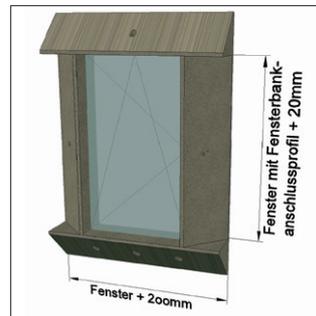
Maße Zuschnitt Zarge für 10 mm Fuge
